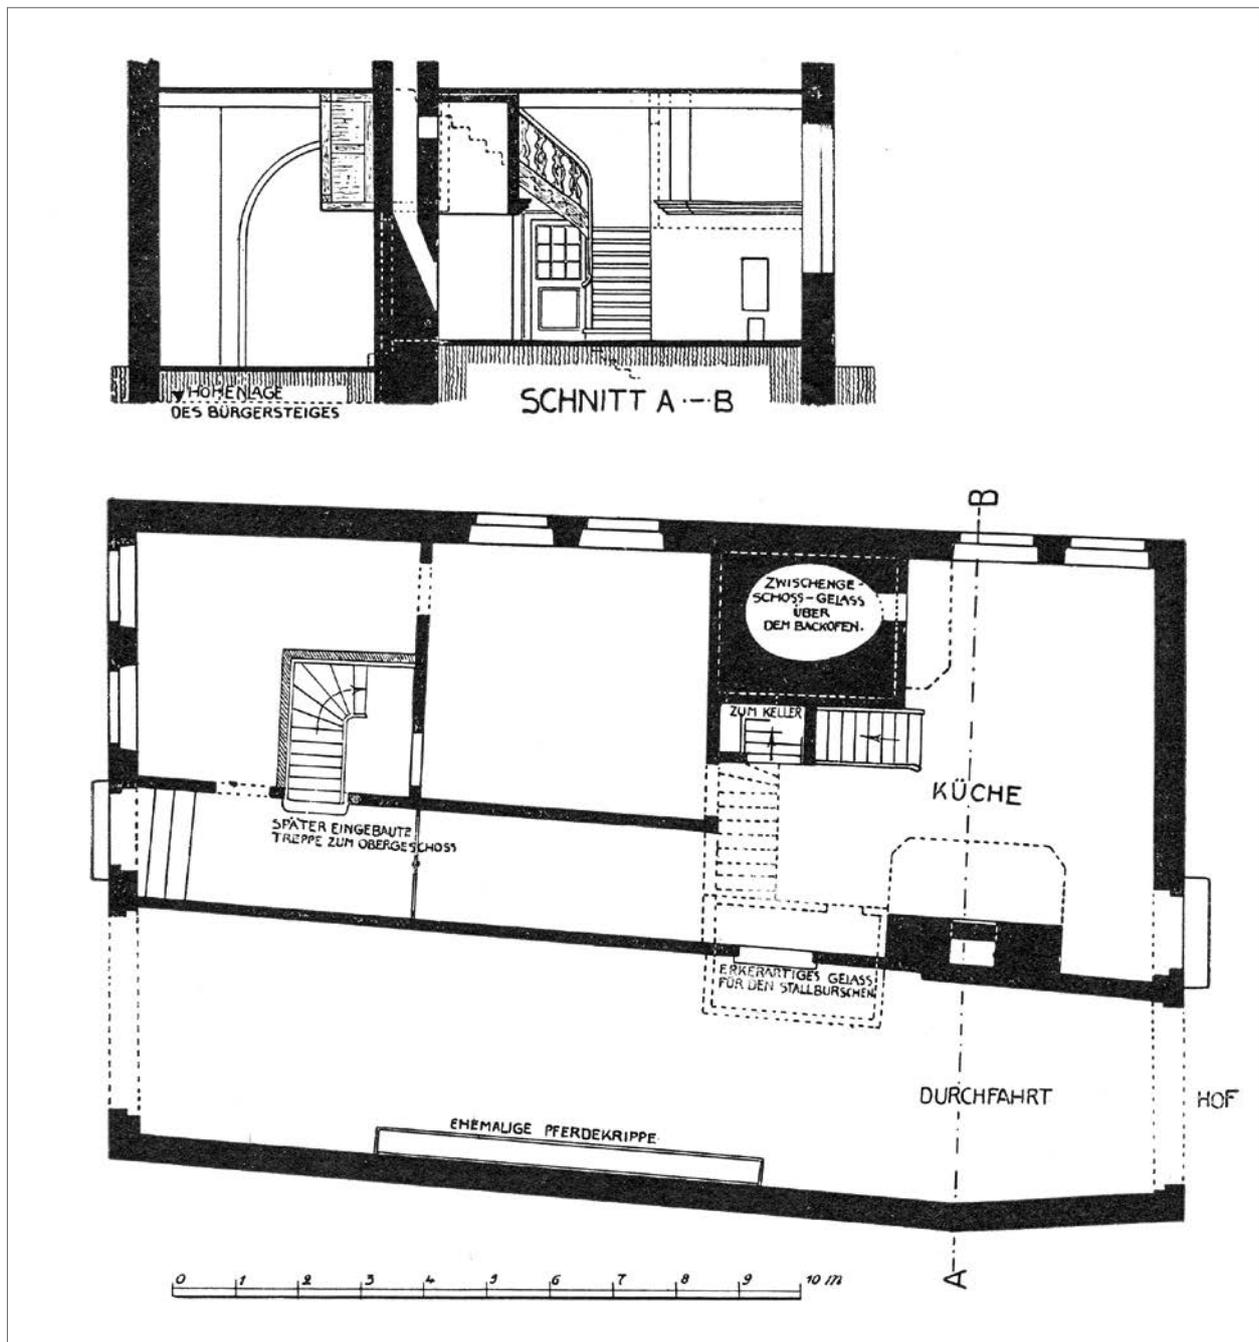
Grundriss des Hauses Greßhoff.
